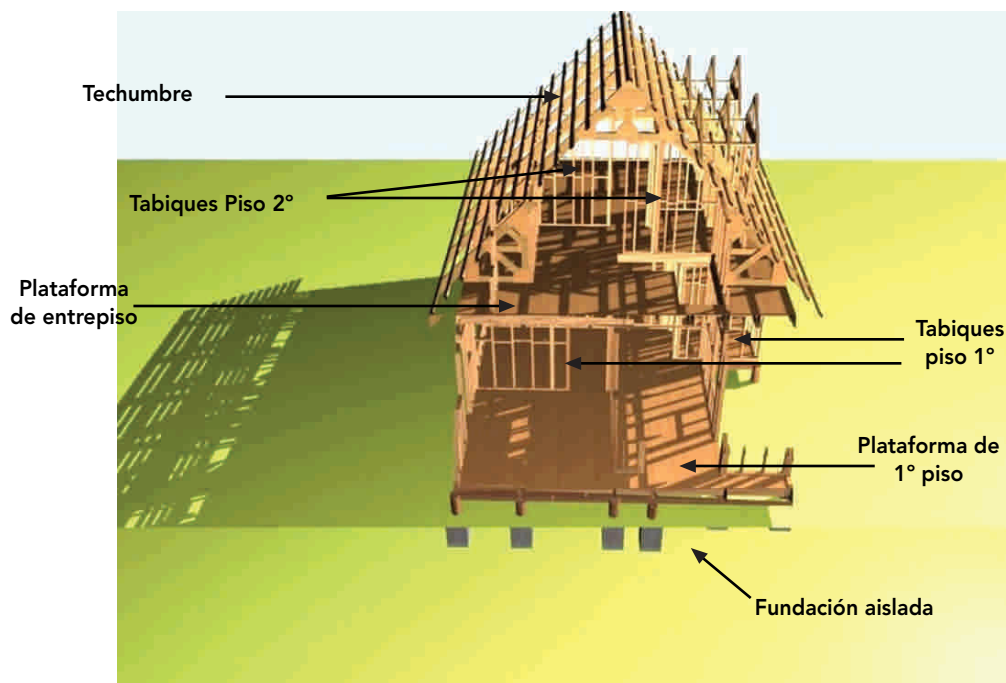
1 : Corte de la vivienda especificando sus componentes estructurales principales.
